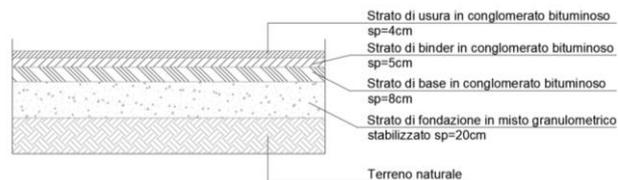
Dettaglio pavimentazione viabilità di accesso
